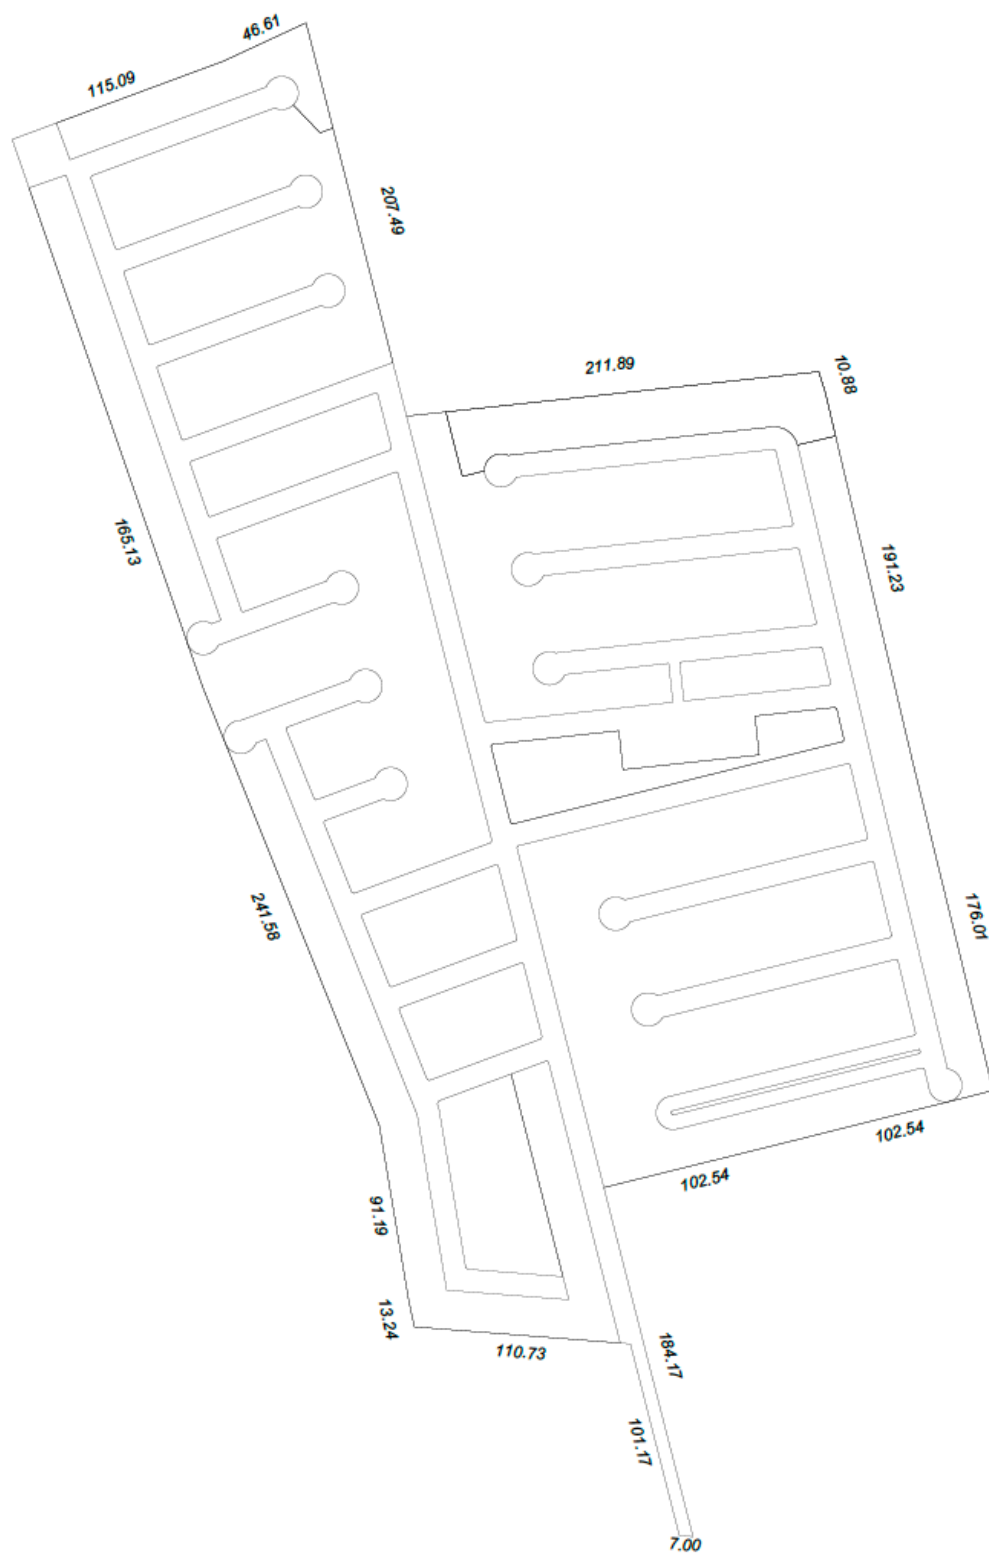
PLANO DE LAS VIALIDADES DEL PROYECTO.
